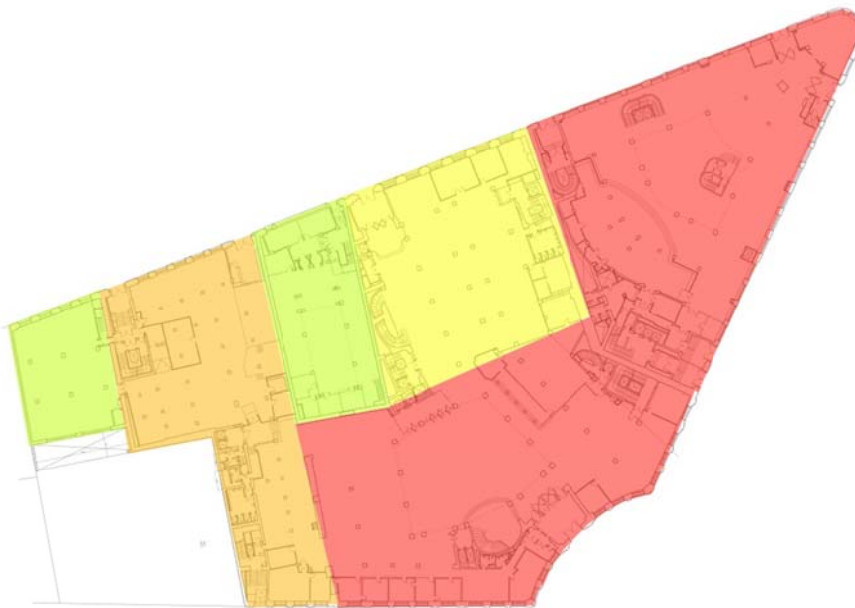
Planta y niveles de protección de los edificios originales: en rojo Alcalá 14 y Canalejas 1 (BIC), en naranja Alcalá 8 con fachada a San Jerónimo 7 (protección integral), en amarillo Alcalá 12 (protección estructural) y en verde Alcalá 6 y Alcalá 10 (protección parcial)
